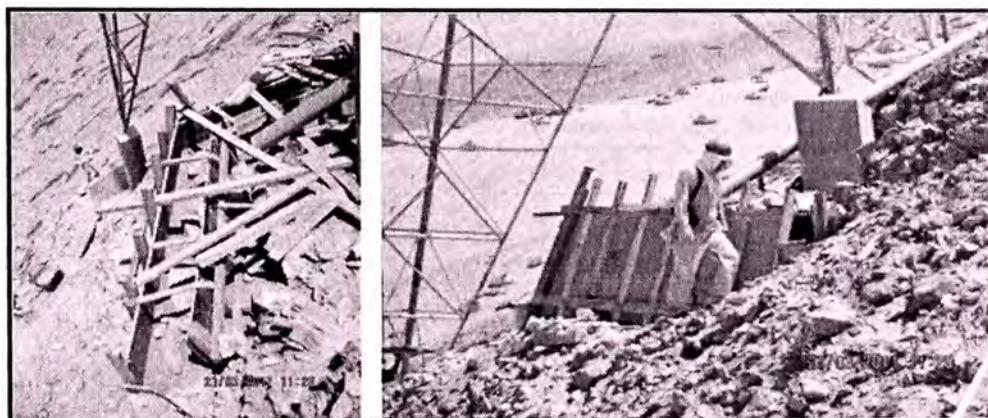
Confinamiento inferior y lateral de los muros en concreto ciclópeo.
